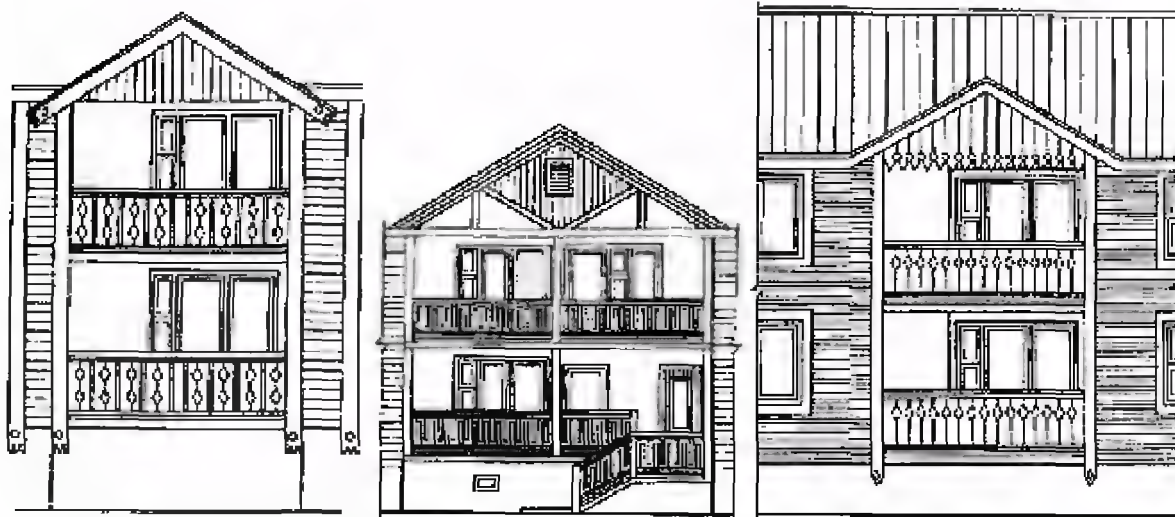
Варианты оформления фасада жилого дома деревянно-панельной конструкции
